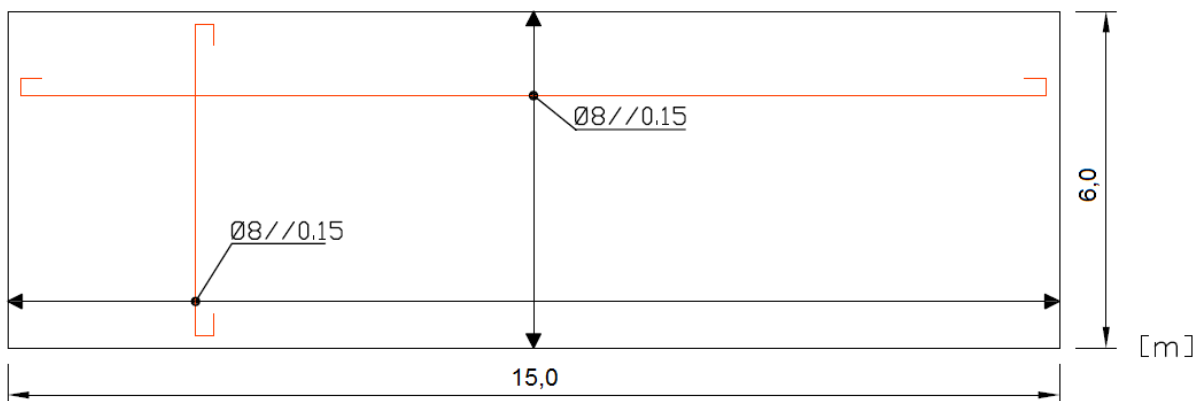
Desenho das armaduras longitudinais na face anterior (inferior).
